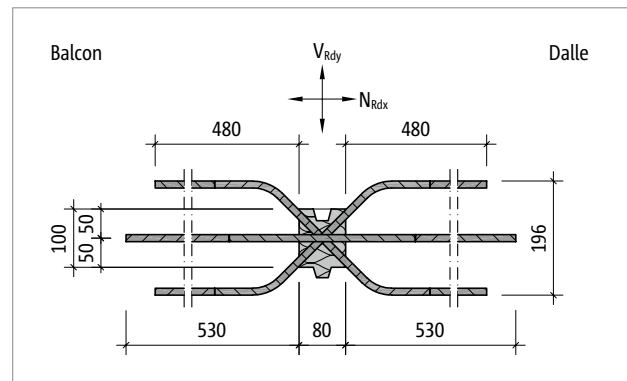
Schöck Isokorb® T Type H-VV2-NN1 : Plan de base du produit
